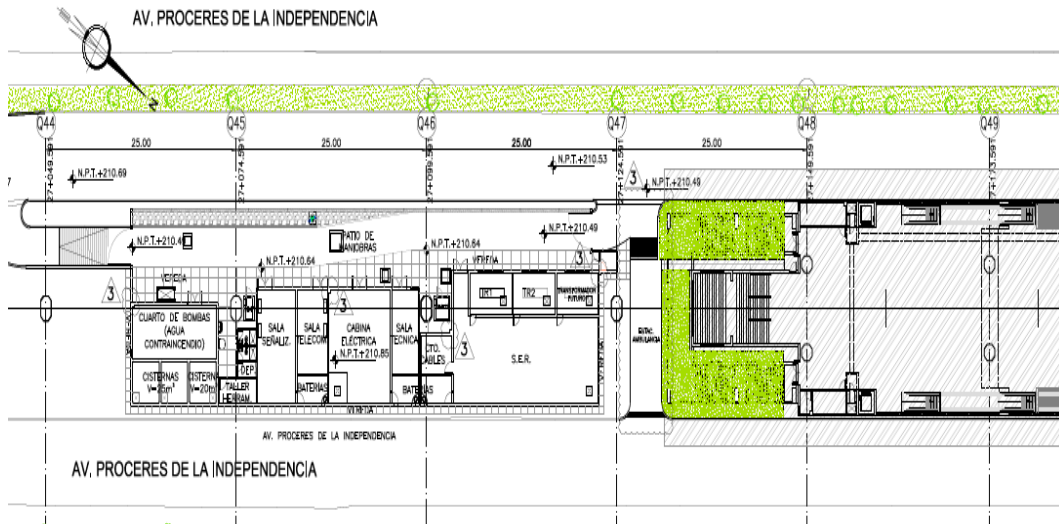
Vista en planta de Ubicación Área Técnica.
